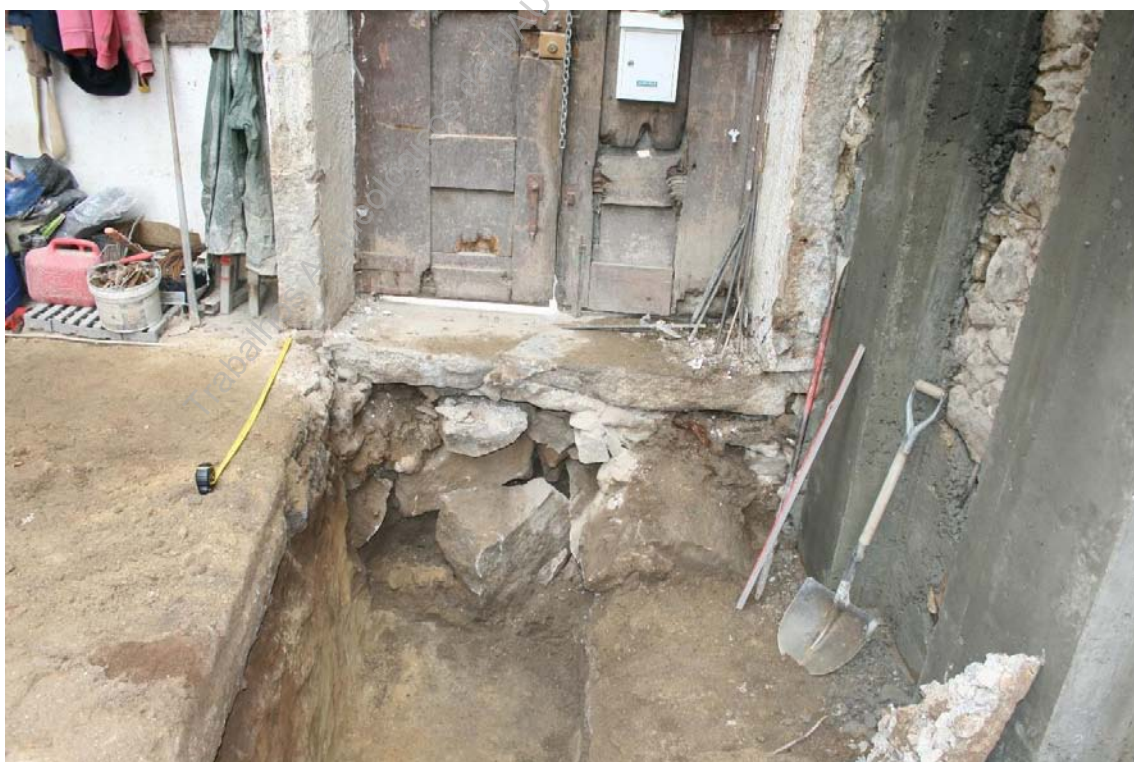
(IMG_9334) – Aspecto de localização de vala para implantação de segunda sapata junto a fachada, zona norte.
